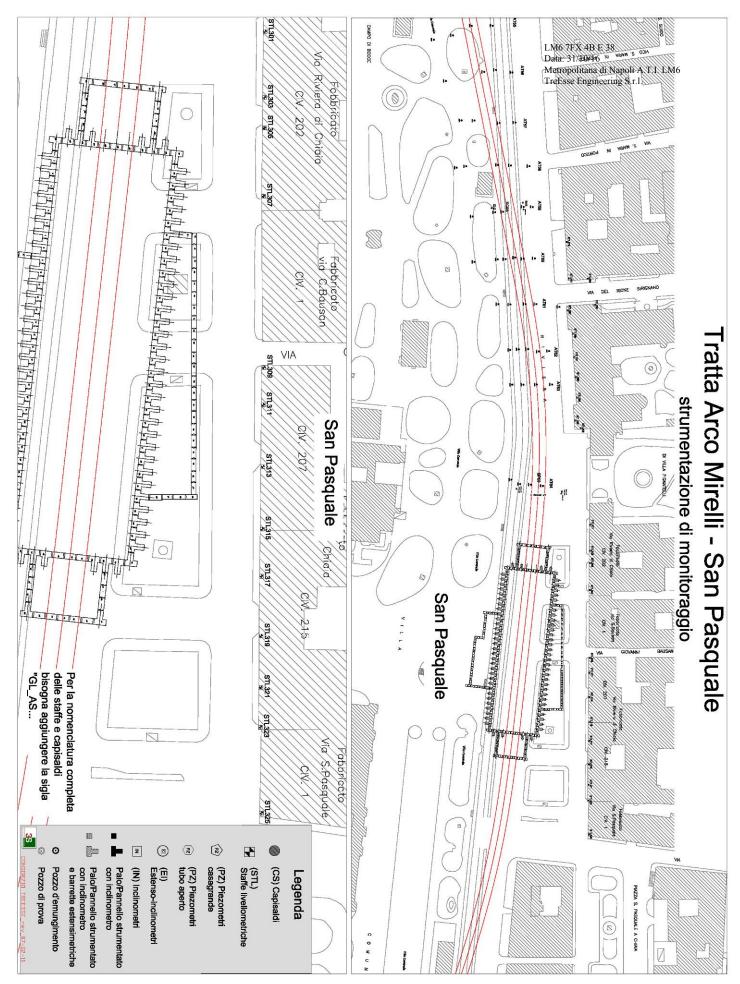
Planimetria tratta Arco Mirelli-SanPasquale, raffigurante la disposizione della terza installazione della strumentazione di monitoraggio.
